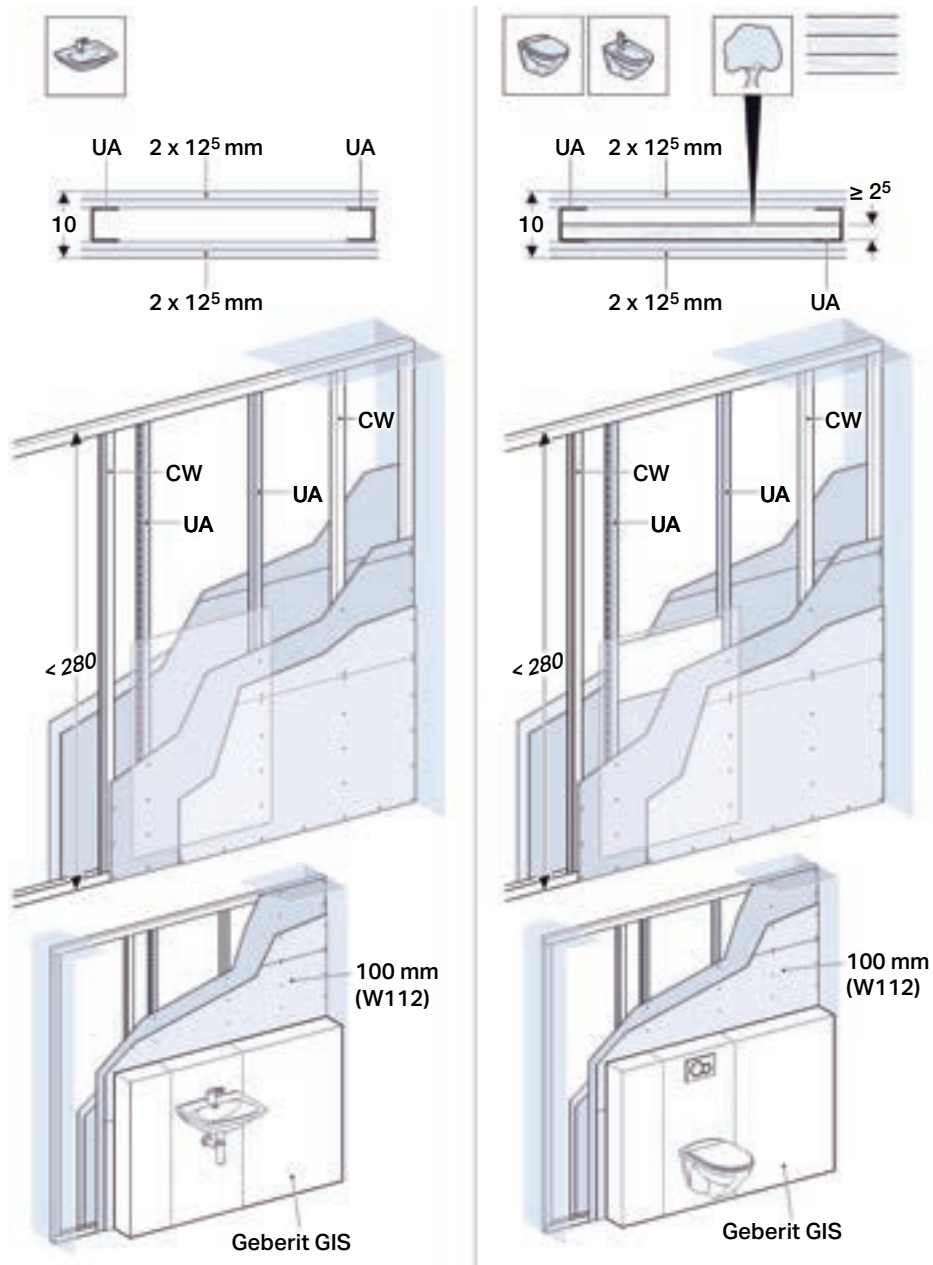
Geberit GIS Vorwand vor 100 mm Leichtbau-Metalständerwand W112 (Einfachständerwand 10 cm dick mit zweilagiger Beplankung)
